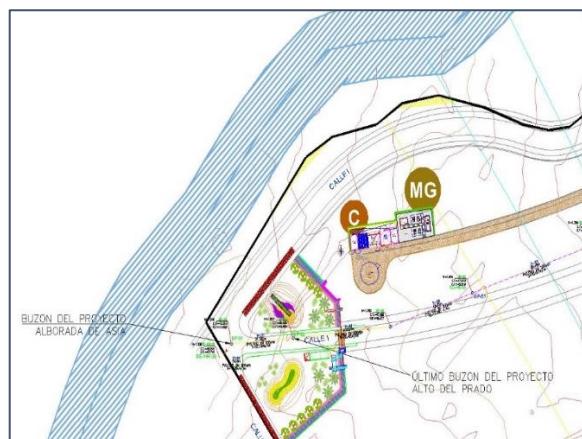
Conexión entre el Colector de Alcantarillado del Proyecto Alto del Prado al Proyecto Alborada de Asia.
